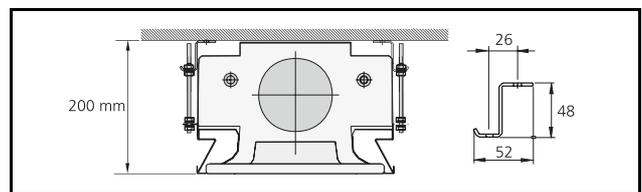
Fixation au plafond Kit de montage MD12S, contre le plafond, vue d'extrémité.
